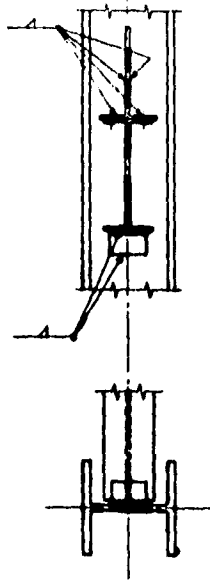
CONEXION DE ASIENTO RIGIDIZADO PARA VIGAS
